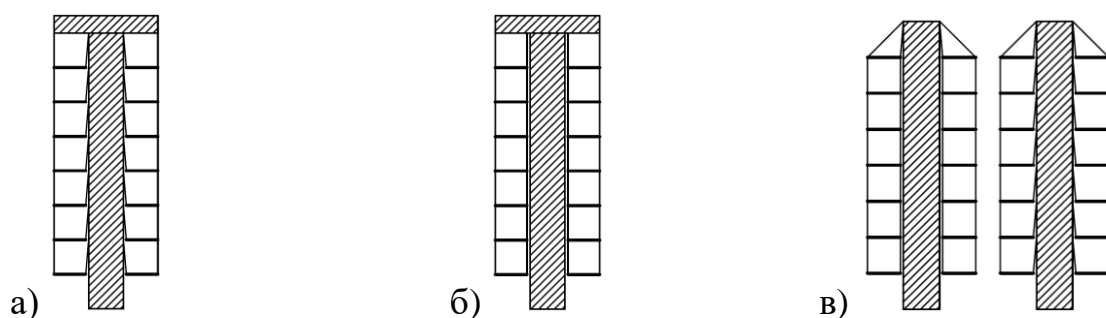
Здания ствольно-подвесной конструктивной системы с передачей нагрузки от перекрытий на: а) ствол и консольный оголовок здания; б) на консольный оголовок здания; в) на ствол здания
